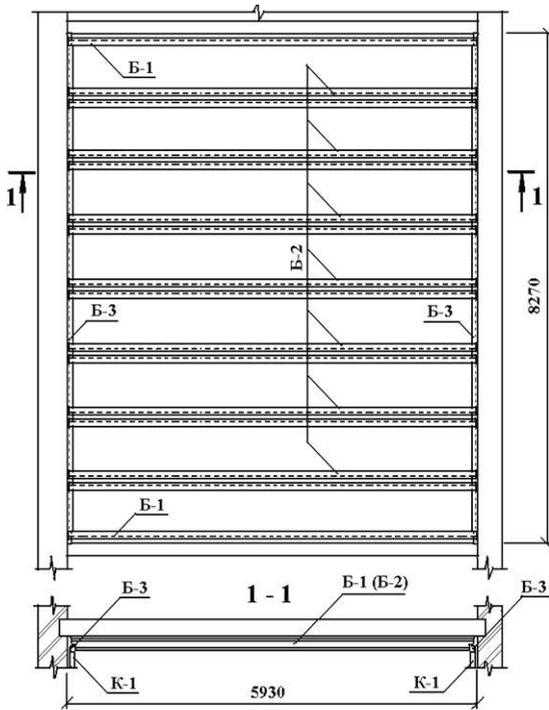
Схема підсилення стін і перекриття у кабінеті № 2 СШ № 14
